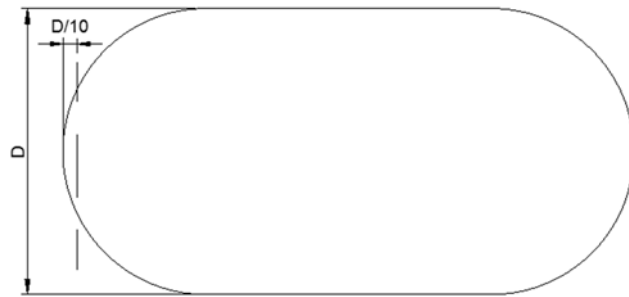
長圓形橋墩基礎之臨界斷面示意圖
